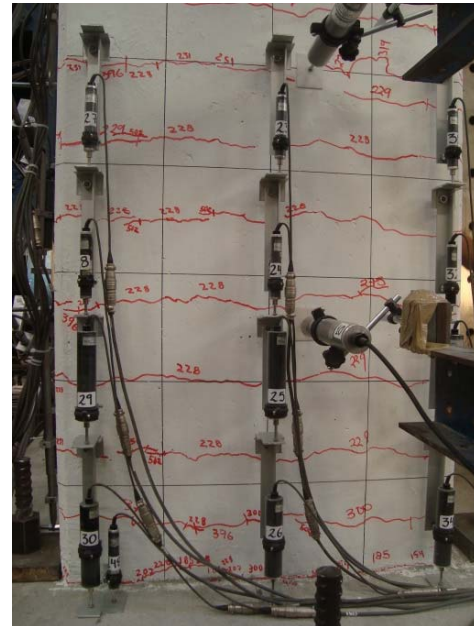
Primeras grietas de flexión de espécimen PH2
